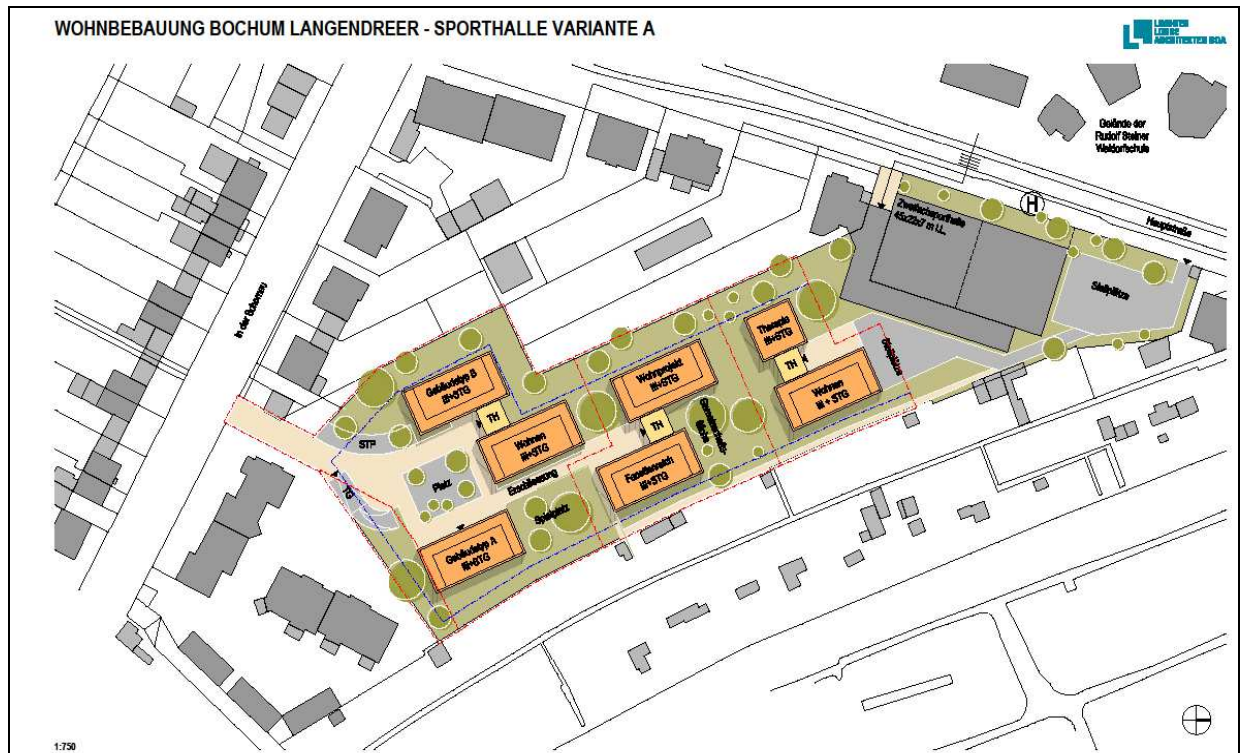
Die städtebauliche Entwurfsplanung des Bebauungsplans Nr. 417 b
